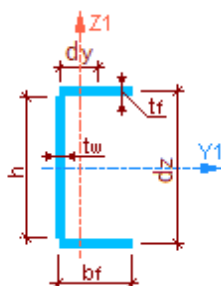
Схема профиля Швеллер сварной
